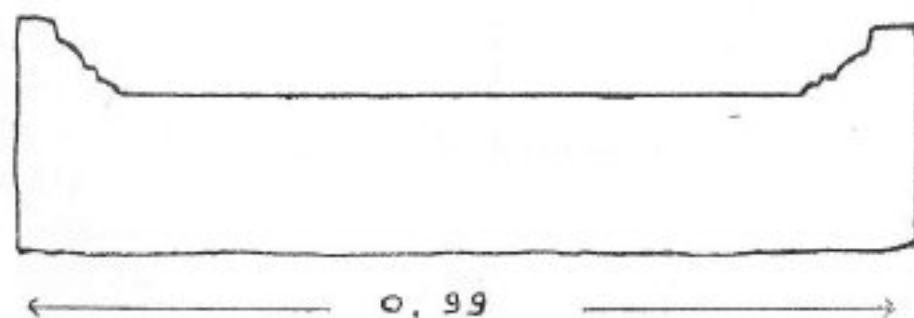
Coupe d'une des dalles en granit se trouvant dans la basilique.
